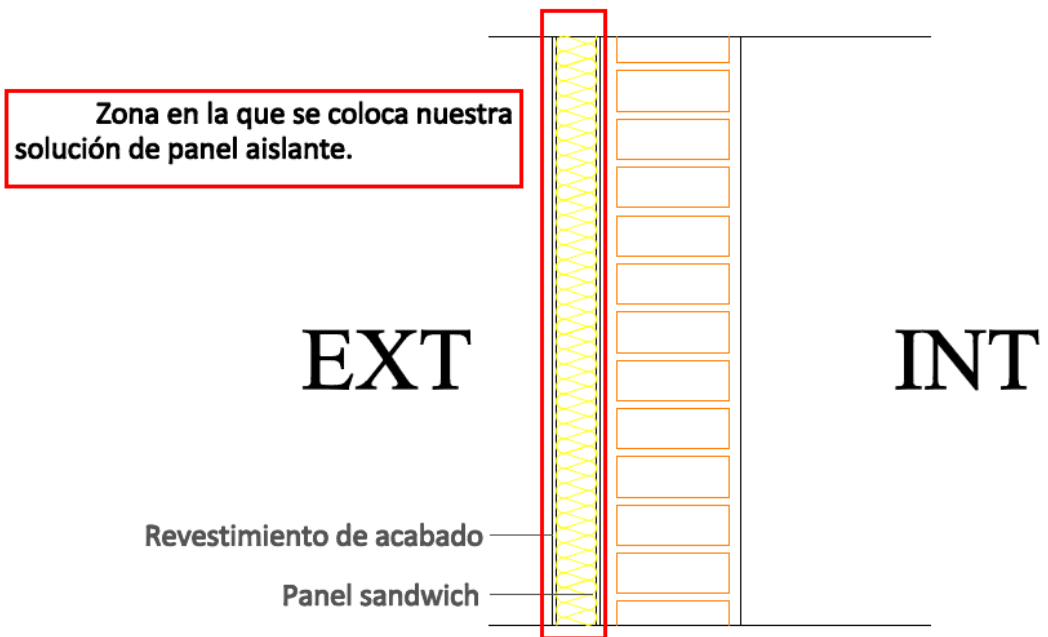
Detalle solución exterior con panel aislante tipo sandwich.
